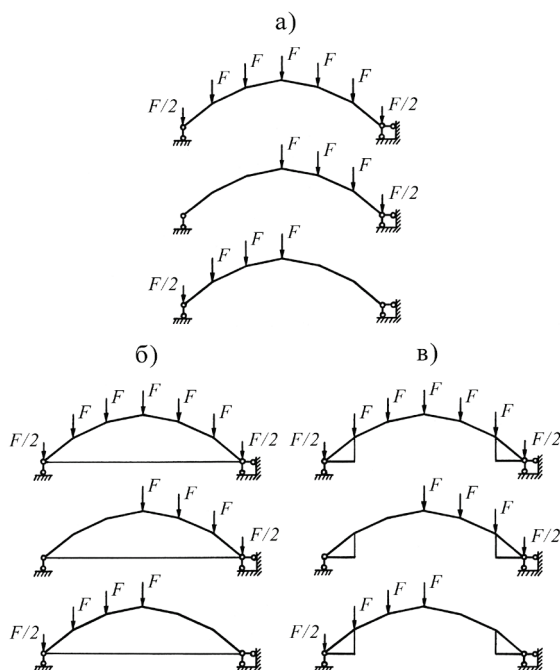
Схеми навантаження моделі: а) без підкріплюючих елементів; б) з затяжками; в) з горизонтальними фермами
